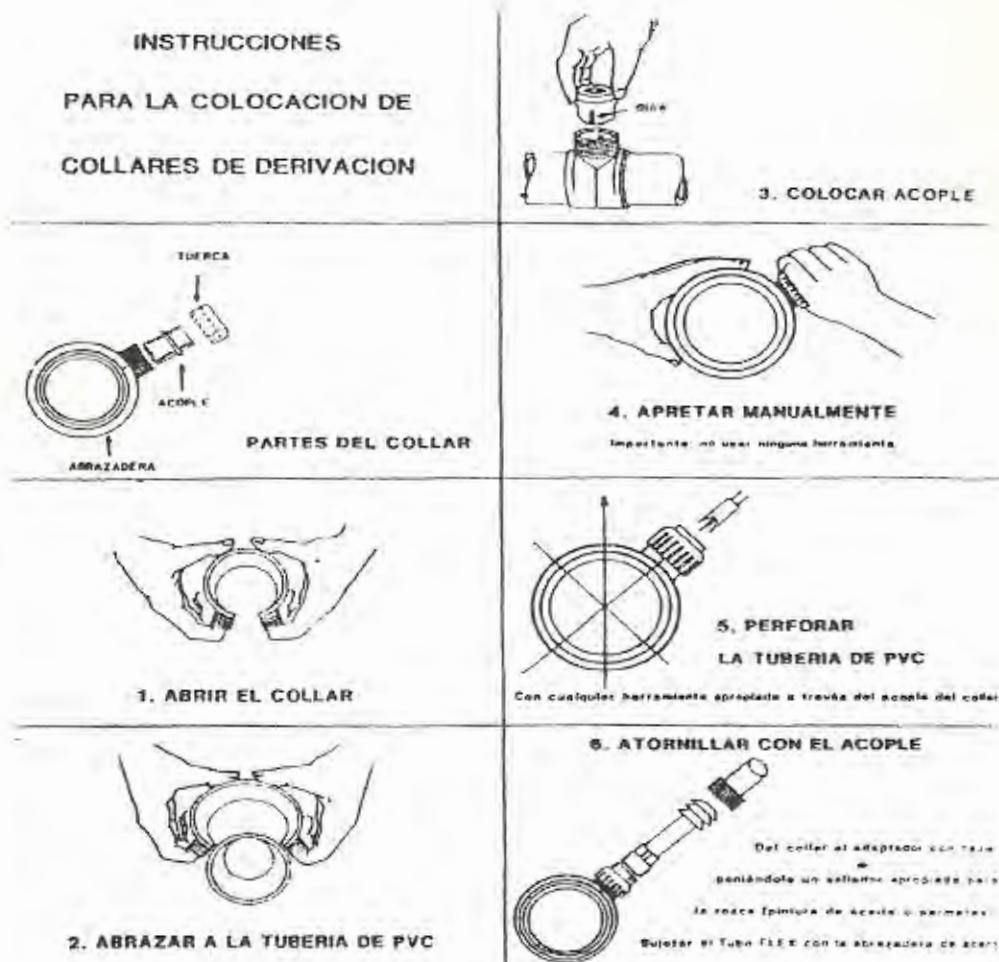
INSTRUCCIONES PARA LA COLOCACIÓN DE COLLARES
